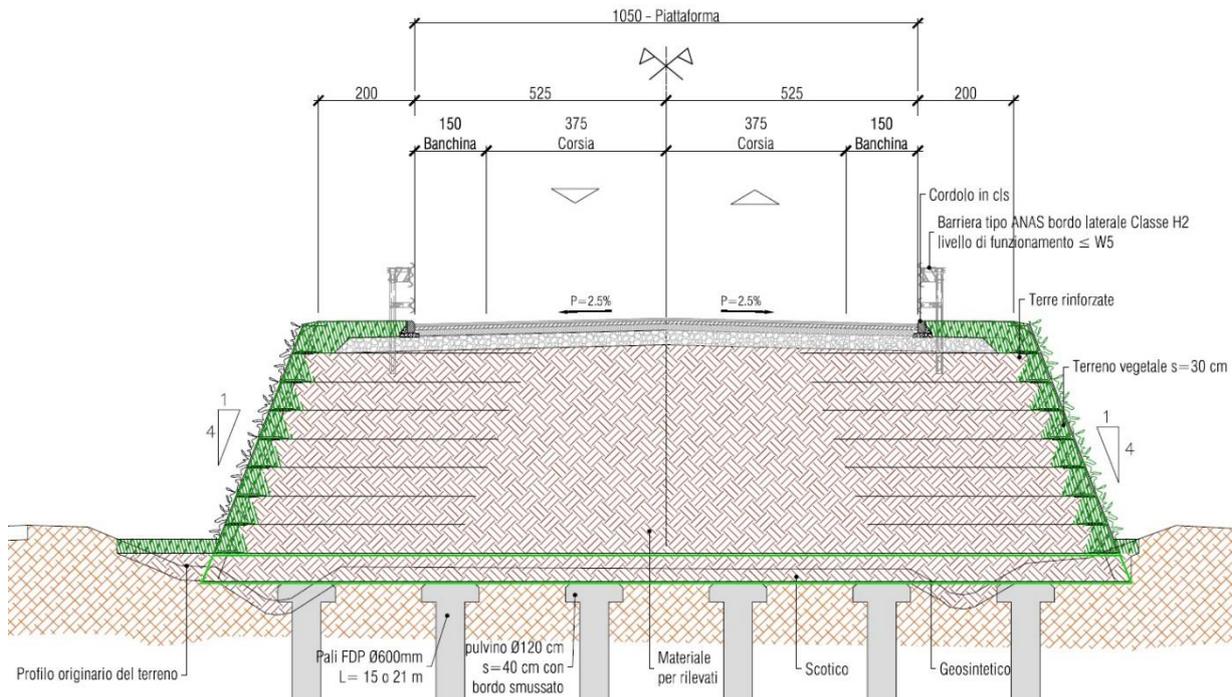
SEZIONE TIPO DI PROGETTO IN RILEVATO CON TERRE RINFORZATE "CALVECCHIA"
